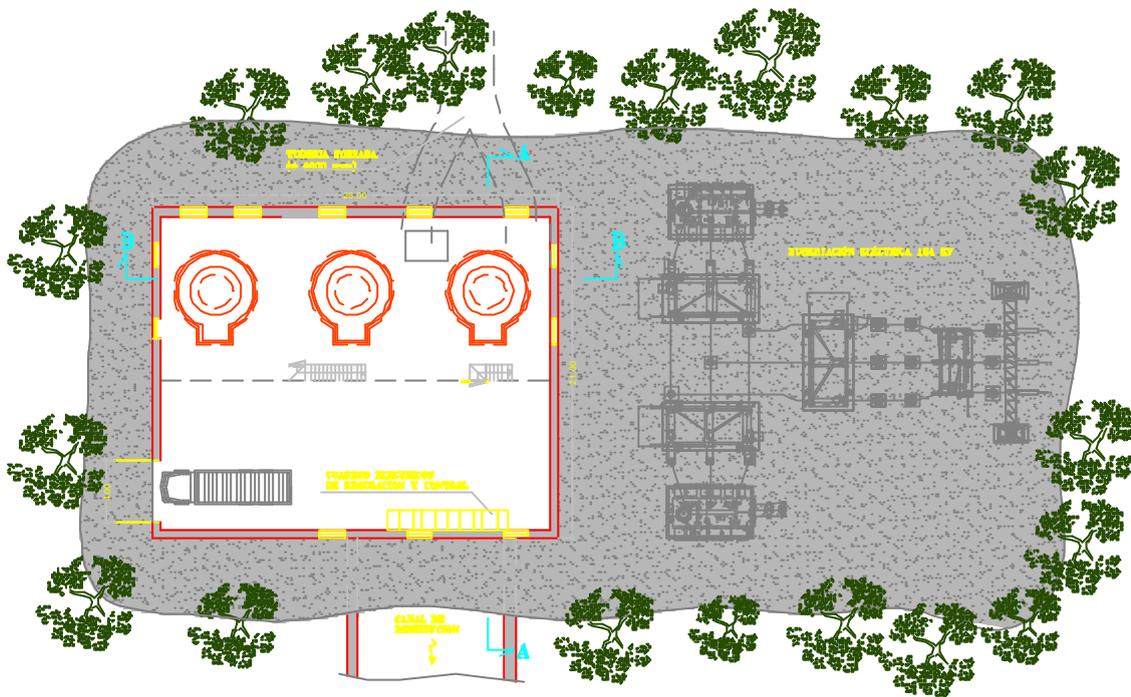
Vista en Planta de Casa de Maquinas y Subestación eléctrica
